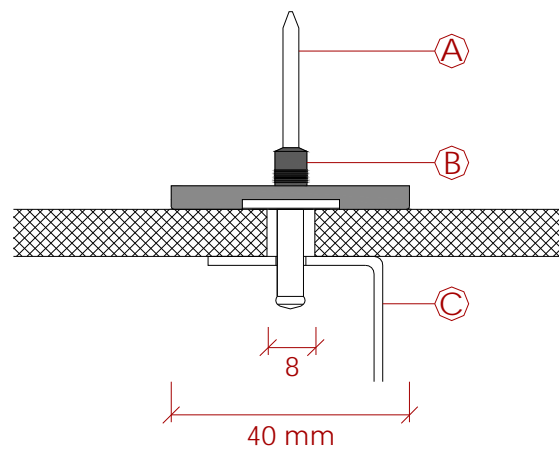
Rivet de fixation des plaques COPANEL sur ossature aluminium
